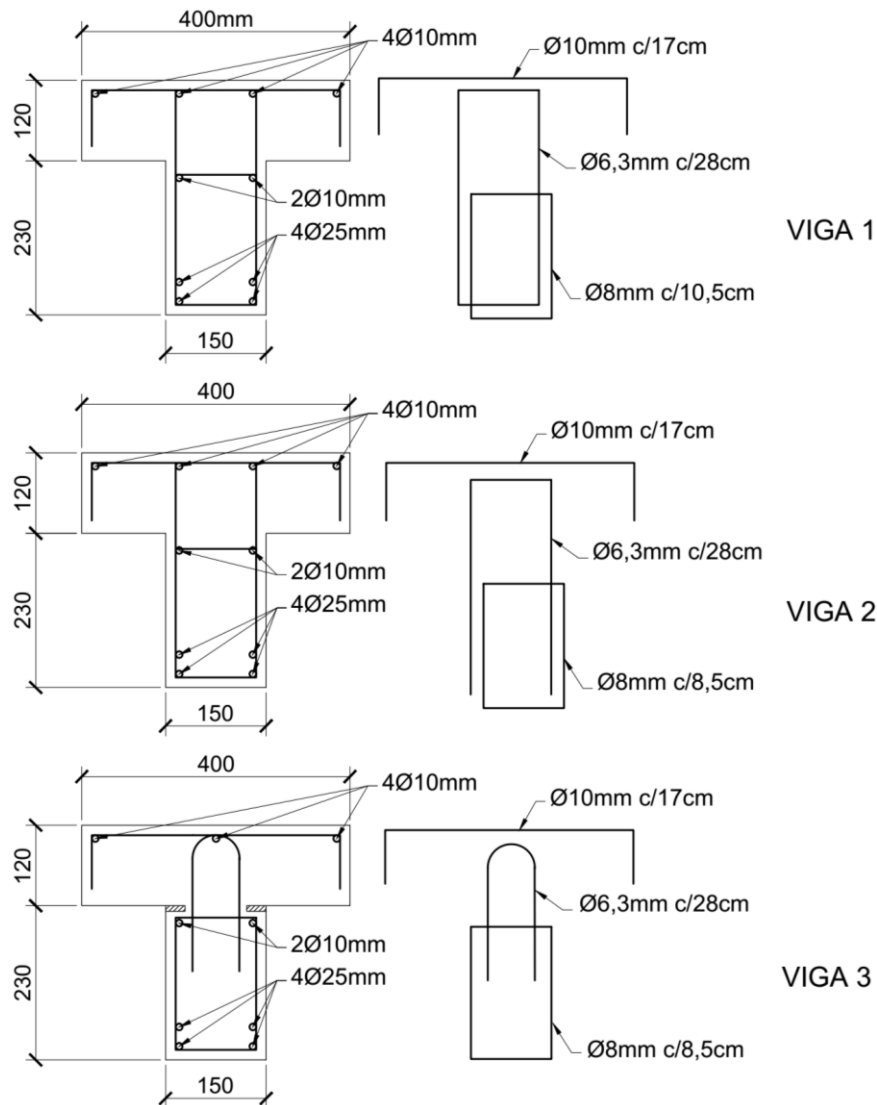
Detalhamento das vigas ensaiadas (ARAÚJO, 1997).
